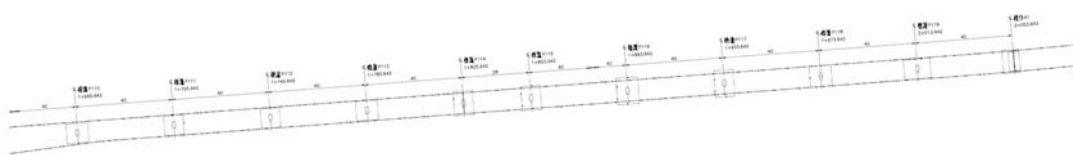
和美交流道匝道一高架橋平面圖單元三與四
